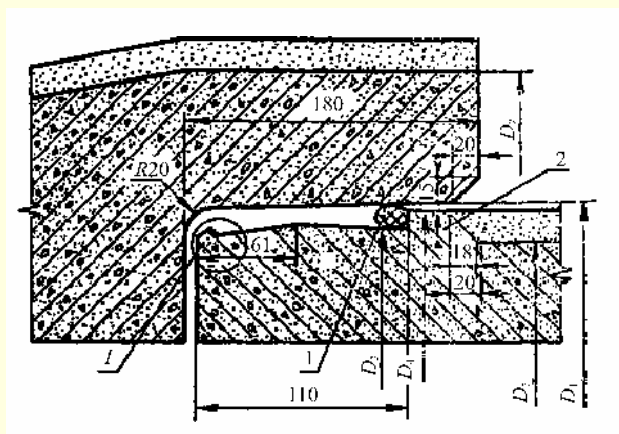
Деталь стыкового соединения труб:
